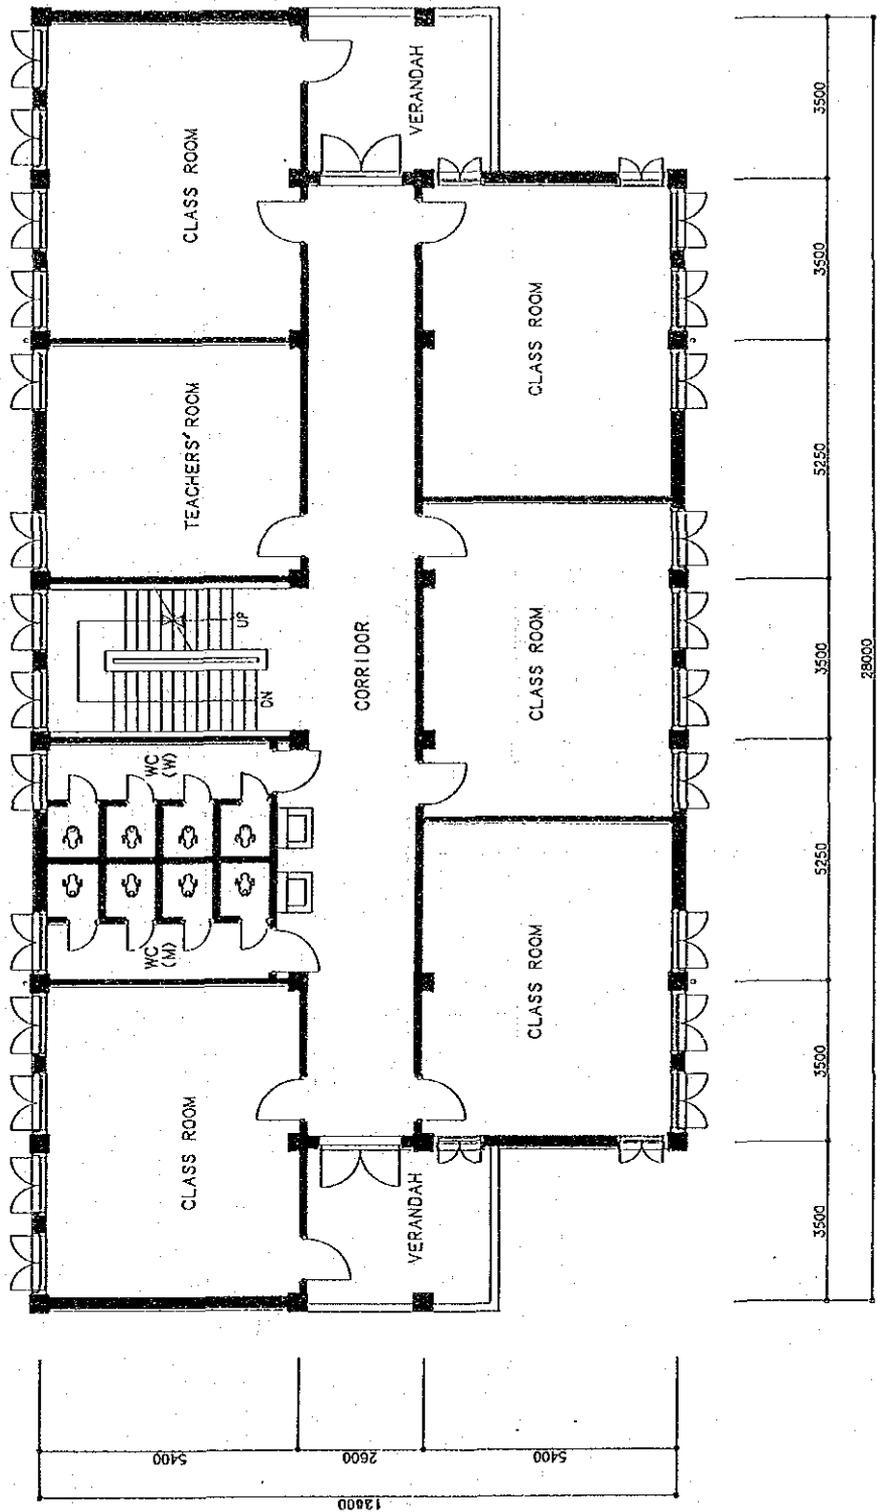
(2) 2階平面図 (5教室タイプ)
